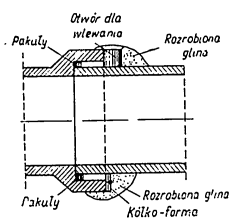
Forma dla zalewania styków rur masą izolacyjną
